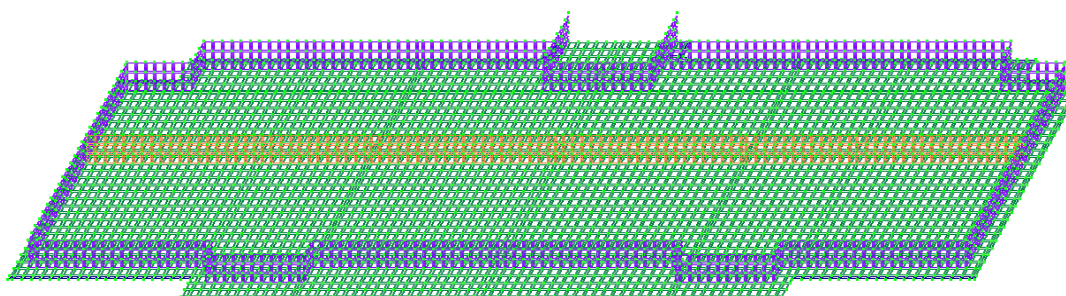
Расчетная модель фундаментной плиты №14
